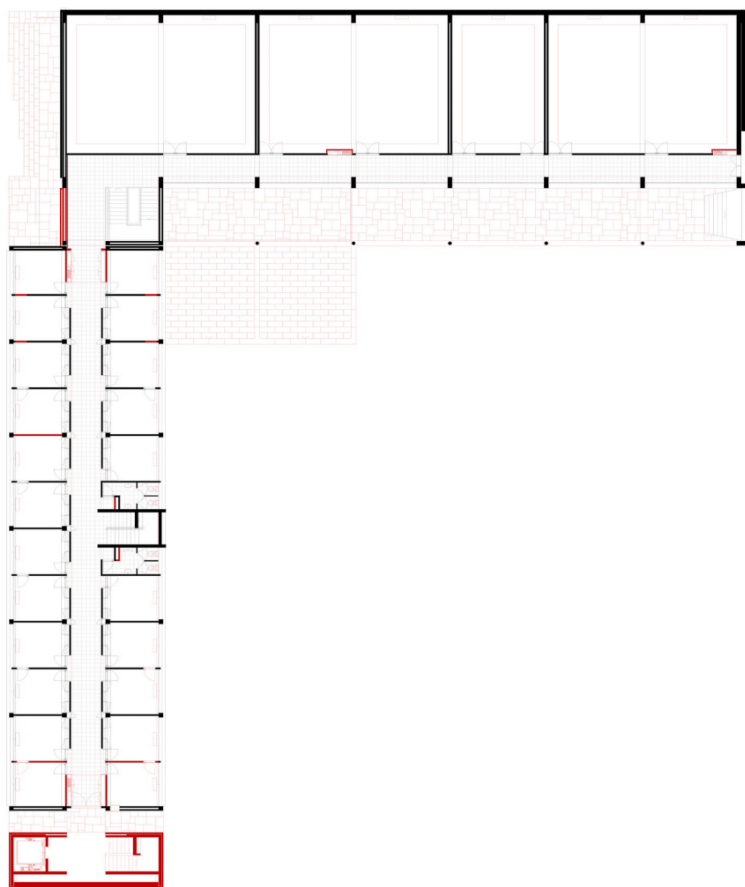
Planta da Proposta de Gonçalo Byrne
